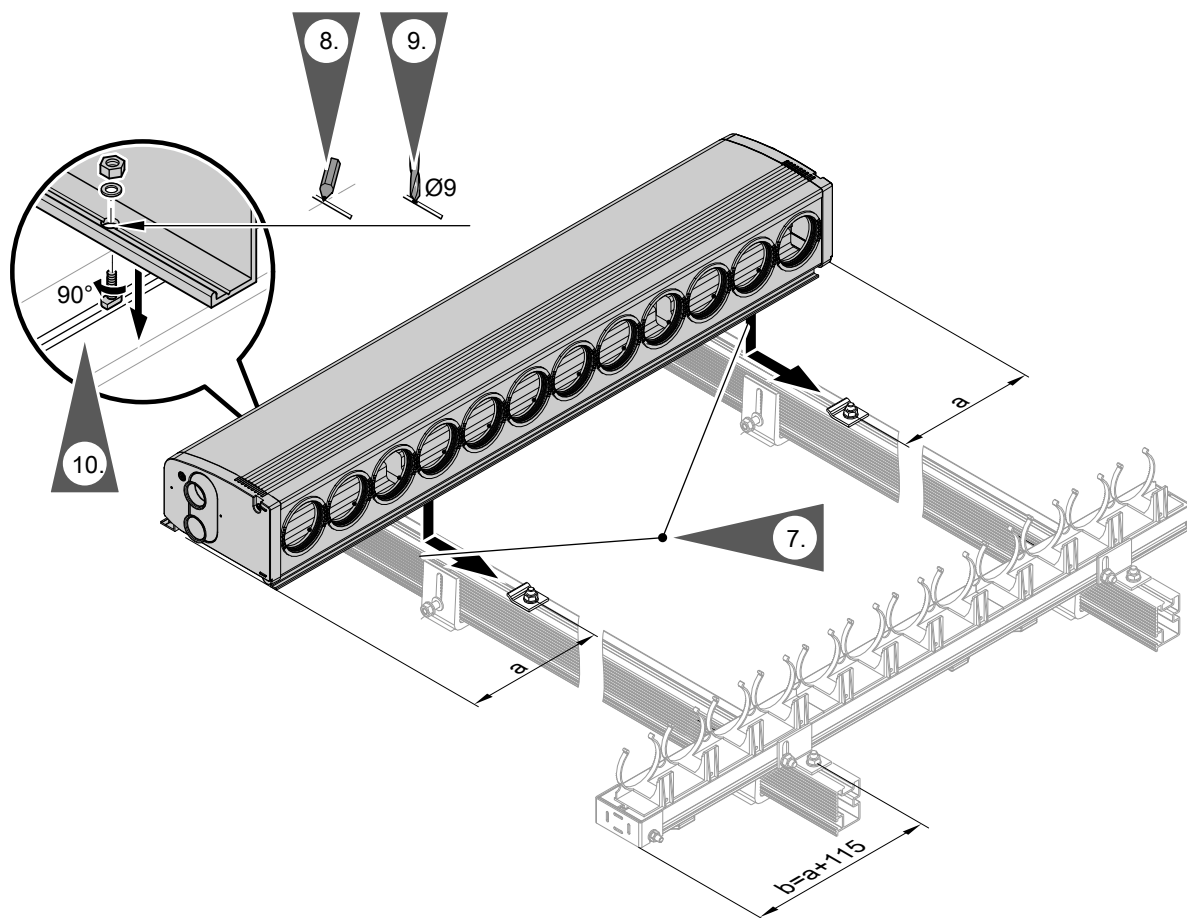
Размер *a* определяется после расположения соединительного корпуса по центру монтажных шин.
